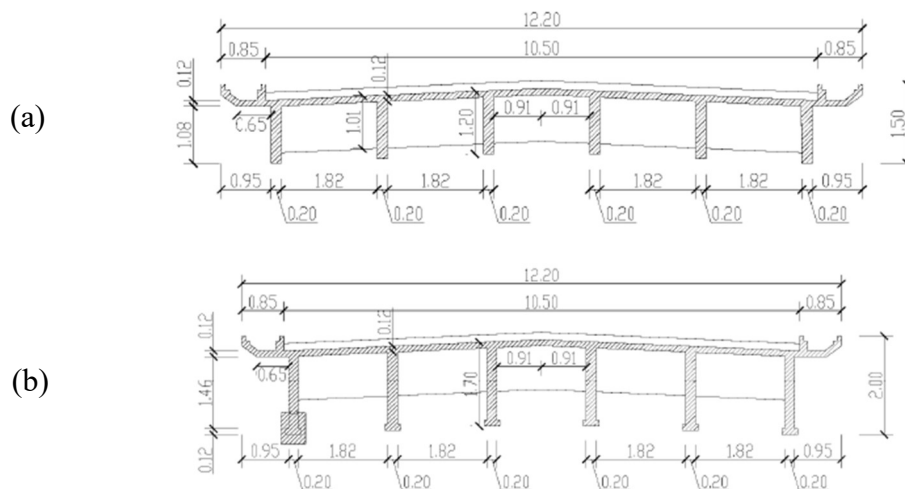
Sezioni trasversali del viadotto: (a) sezione trasversale delle campate 1 e 4; (b) sezione trasversale delle campate 2 e 3
